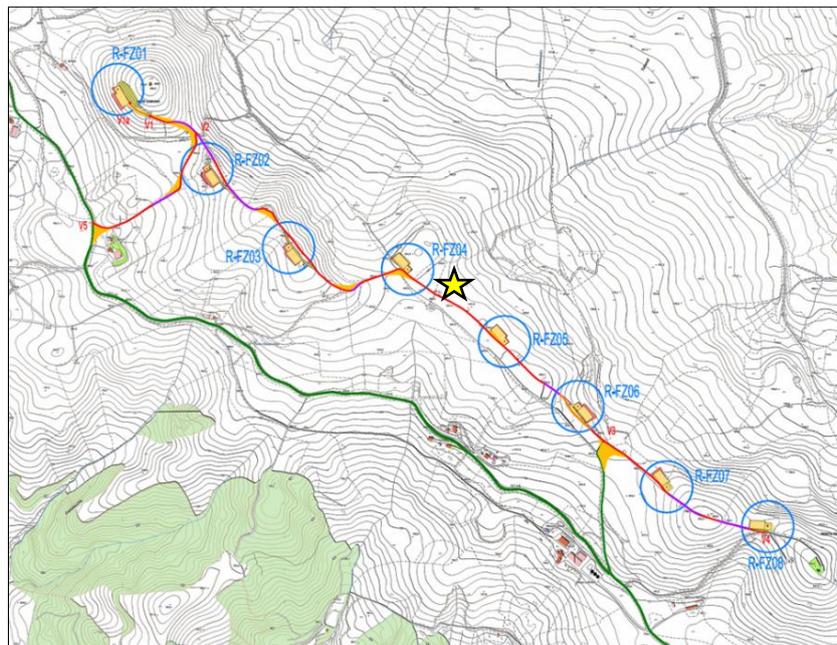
Area centro - Ubicazione area di cantiere ★
